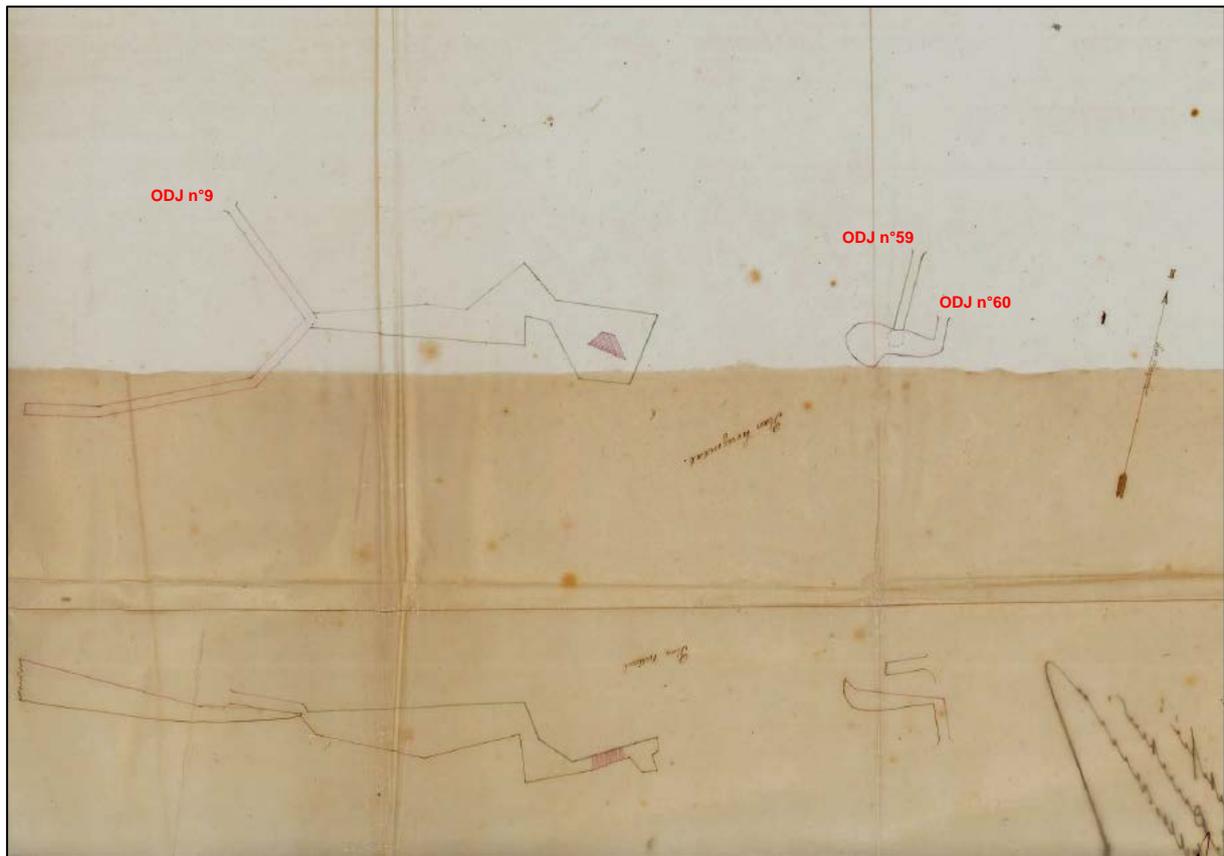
Plan des travaux de la concession du Van (Plan de 1870)
